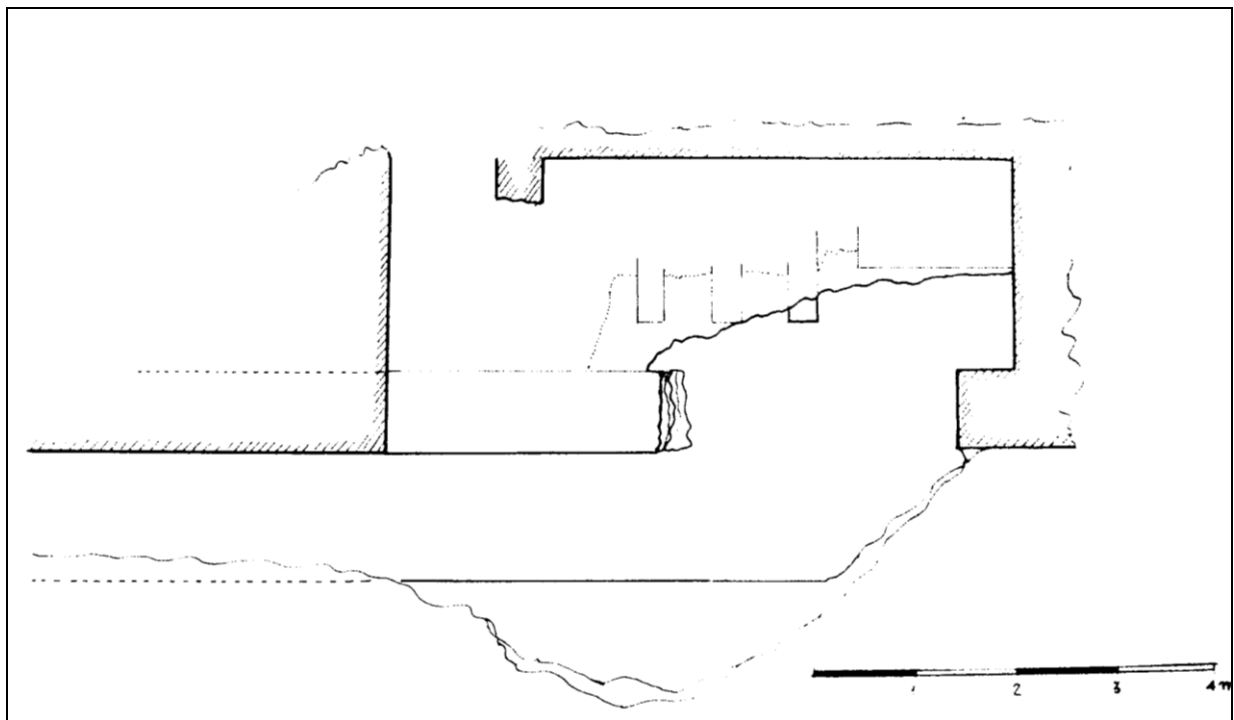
Planimetria dei resti dell'edificio UT 67 (ASSBAR, Collezione disegni).
